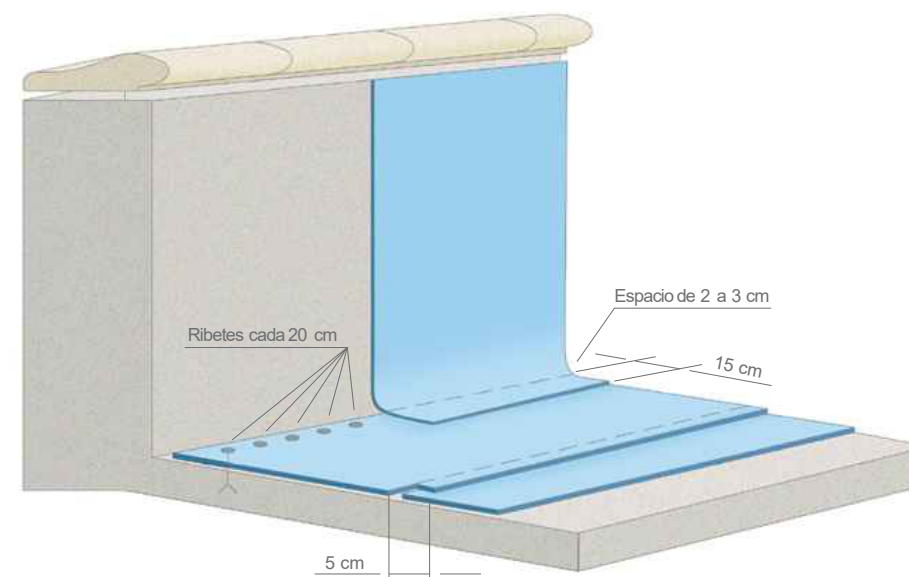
Soldadura pared / fondo (pared rectilínea)
